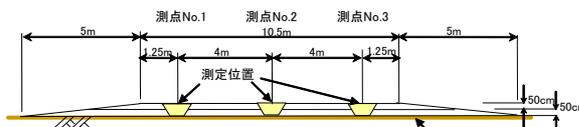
試験施工ヤード側面図(一層の撒き出し厚 50cmの例)
